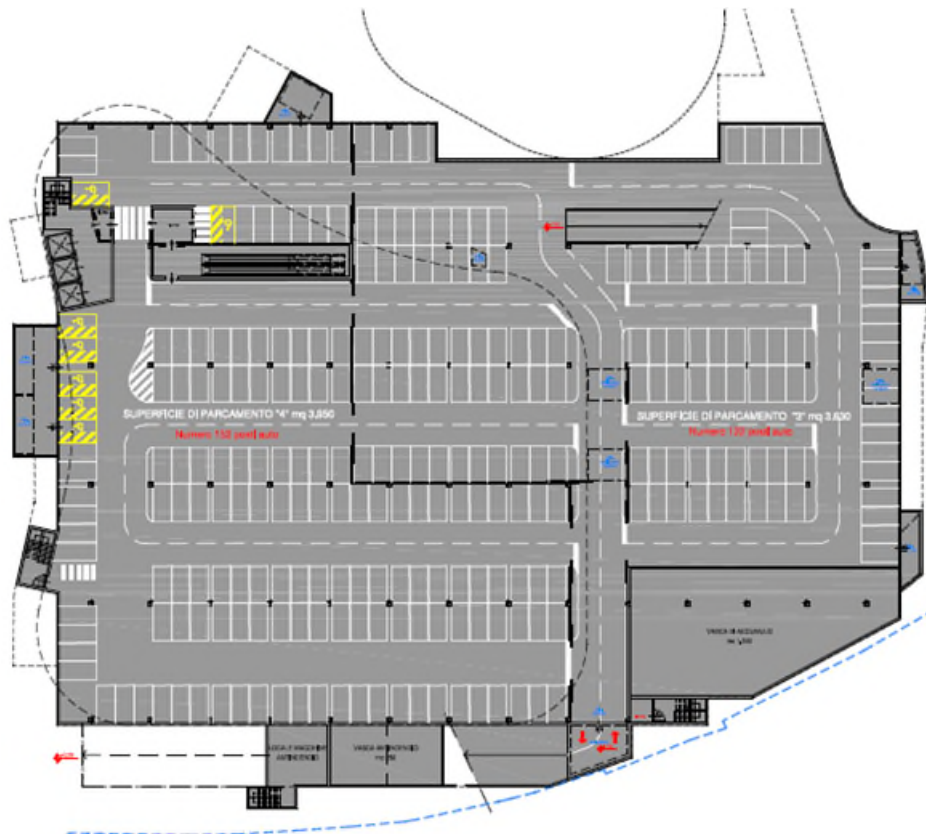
Individuazione aree di sosta – Parcheggio piano -2
